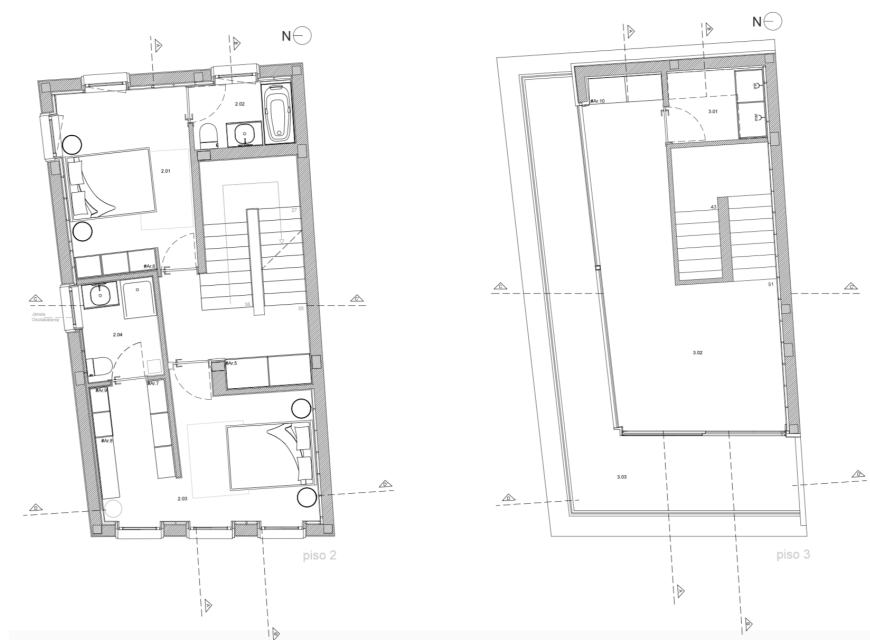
Planta de proposta piso 2 e piso 3. Fonte: Autores
